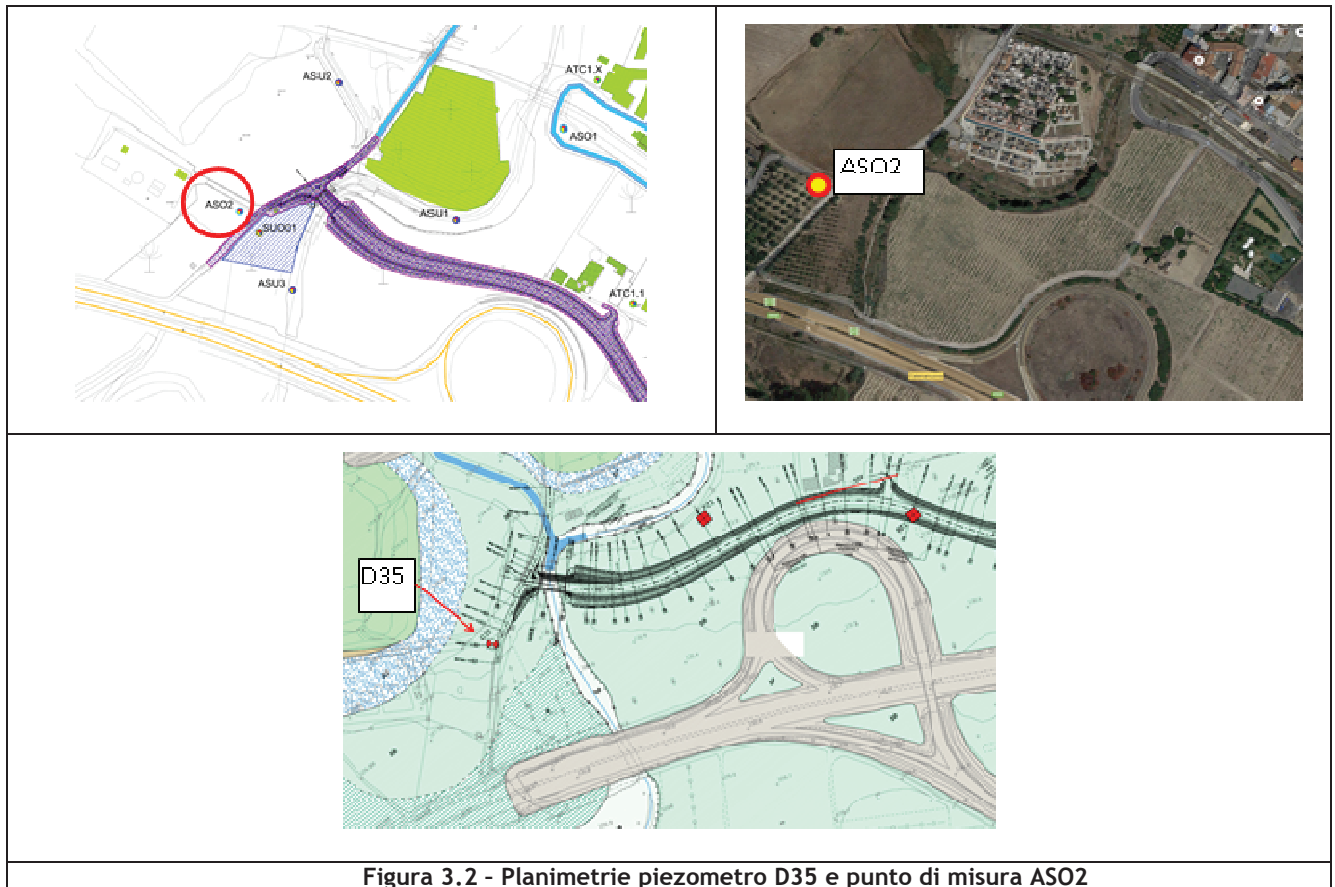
Planimetrie piezometro D35 e punto di misura ASO2
